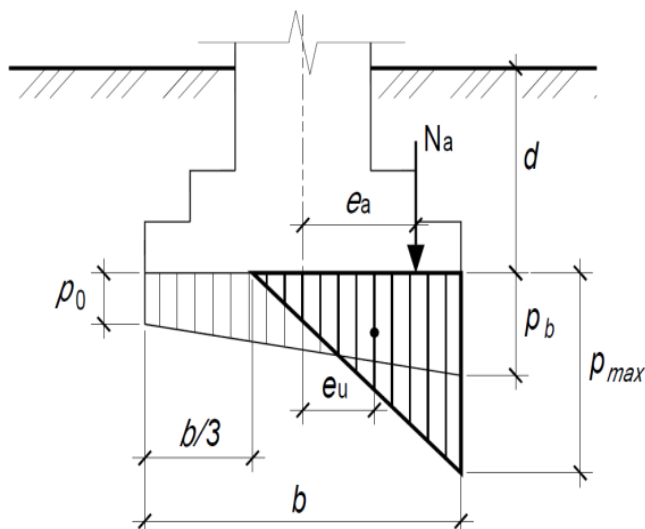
Эпюра предельного давления под подошвой фундамента с частичным отрывом при сейсмическом воздействии
